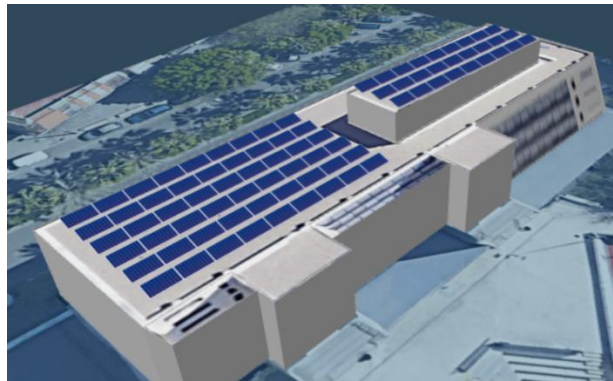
Vista 3D de la planta FV realizada con Solaredge Designer. Fuente: autor.
